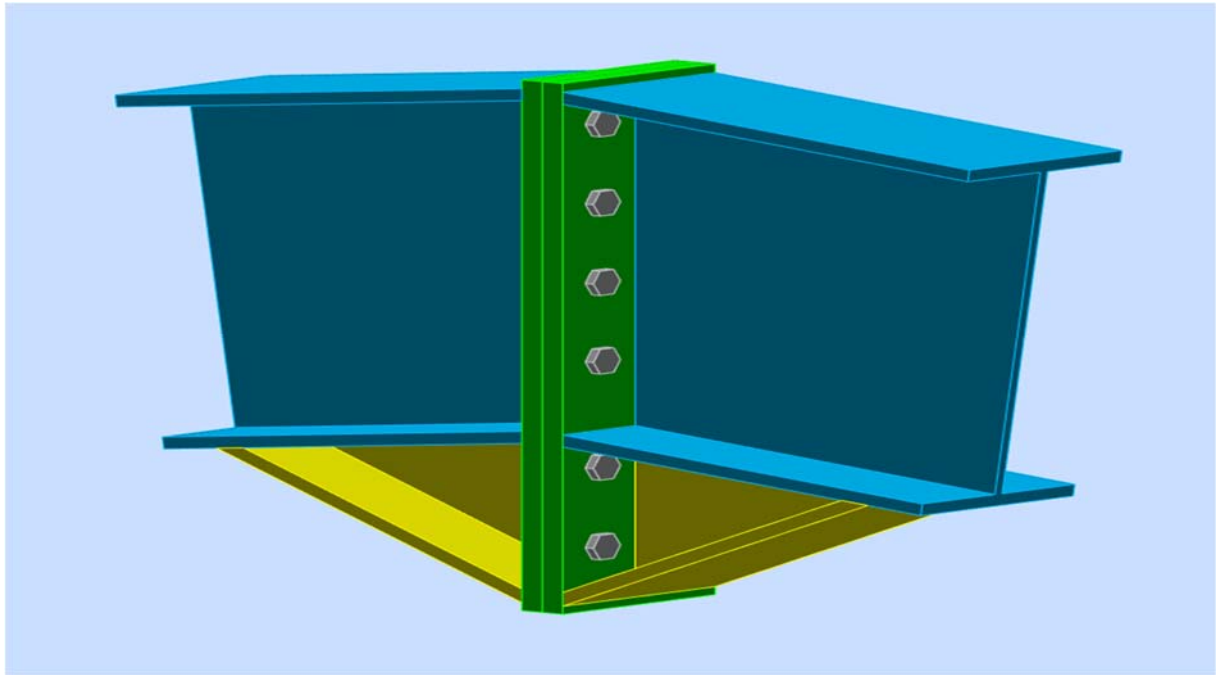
Représentation de l'assemblage traverse-traverse.
